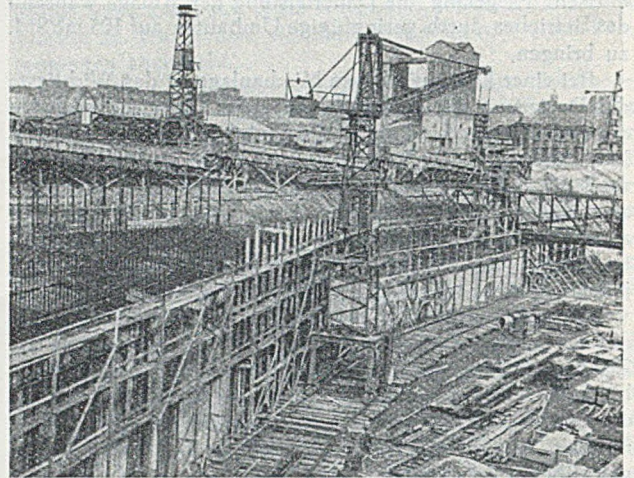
Betonieren der Seitenwände mit Turmdrehkran, im Hintergrund Betonfabrik und Bandstraße.
